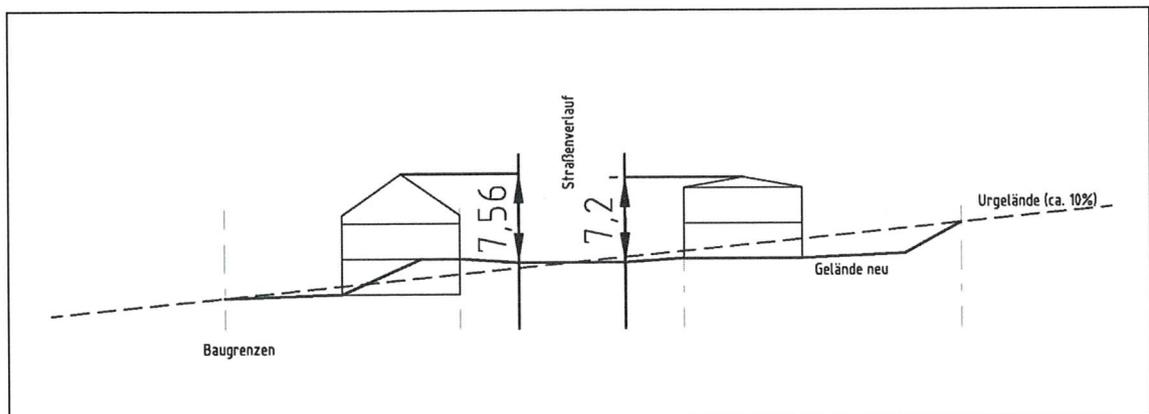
Schemaschnitt Gelände und mögliche Bebauung, unmaßstäblich
